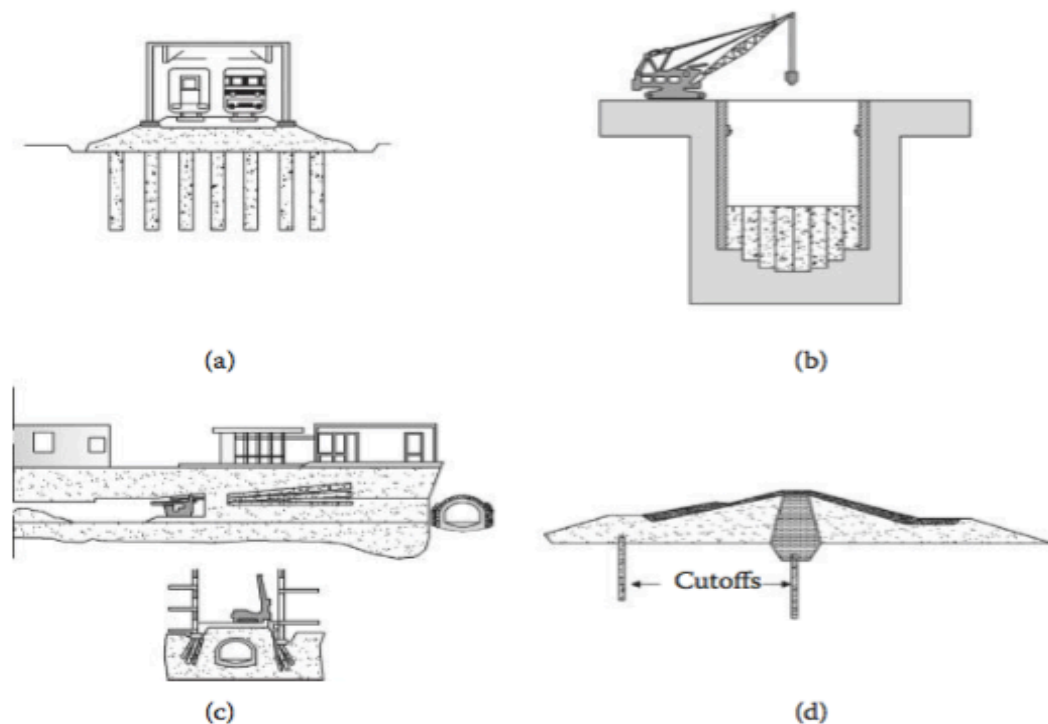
Exemplos comuns de aplicação de *Jet-grouting*. a) fundação de aterros, b) laje de subpressão e suporte de escavação, c) suporte horizontal e subhorizontal de túneis e d) *Cutoff* (Croce *et al*, 2014)
